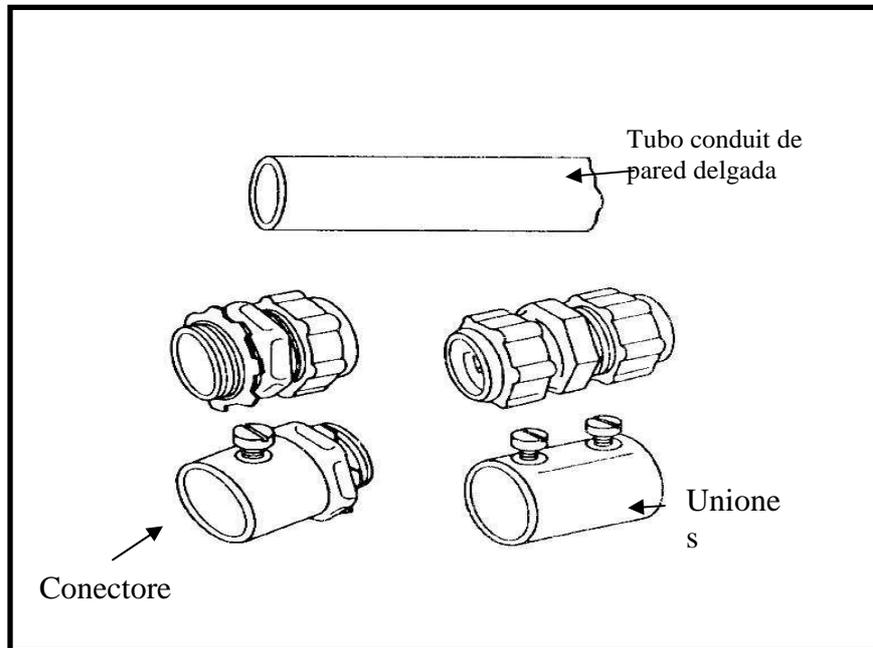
Tubo conduit de pared delgada con conectores y uniones
